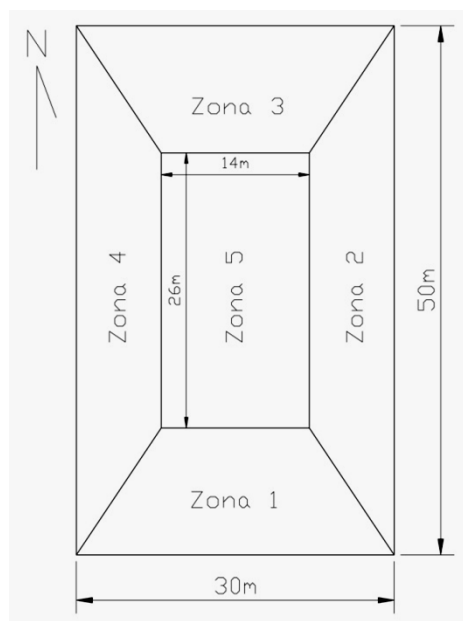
Modelo-base 1 - planta baixa esquemática do térreo, pavimento tipo e cobertura.
